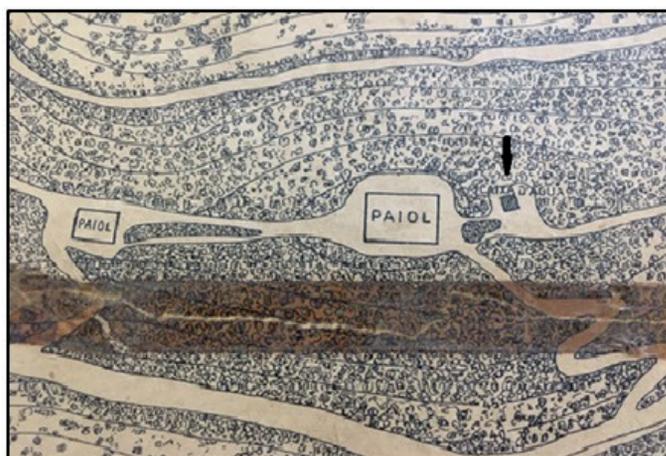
Detalhe da planta da Fortaleza de São João – Cap Volmér Augusto da Silveira – 1916
